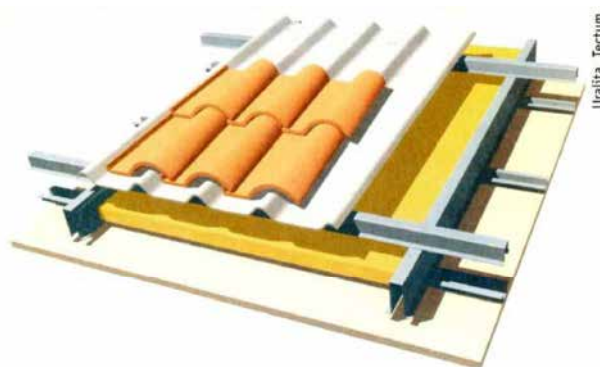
Sistema de Cubierta Ventilada con hoja interna aislada y hoja externa de chapa metálica y tejas de barro.
